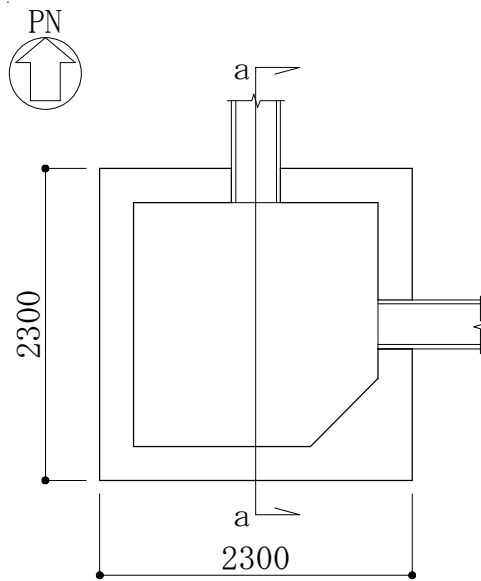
集水ピット及び集水管の概略平面図（南西隅）
